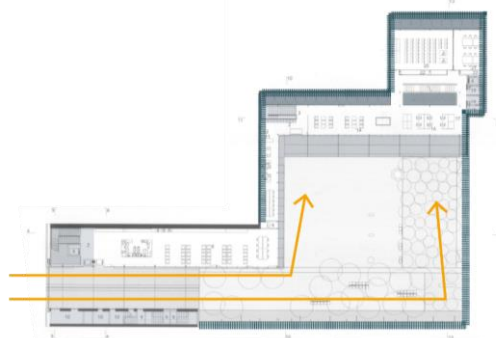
Planta Baja de Biblioteca Sant Antoni, RCR. Modificación Propia.
